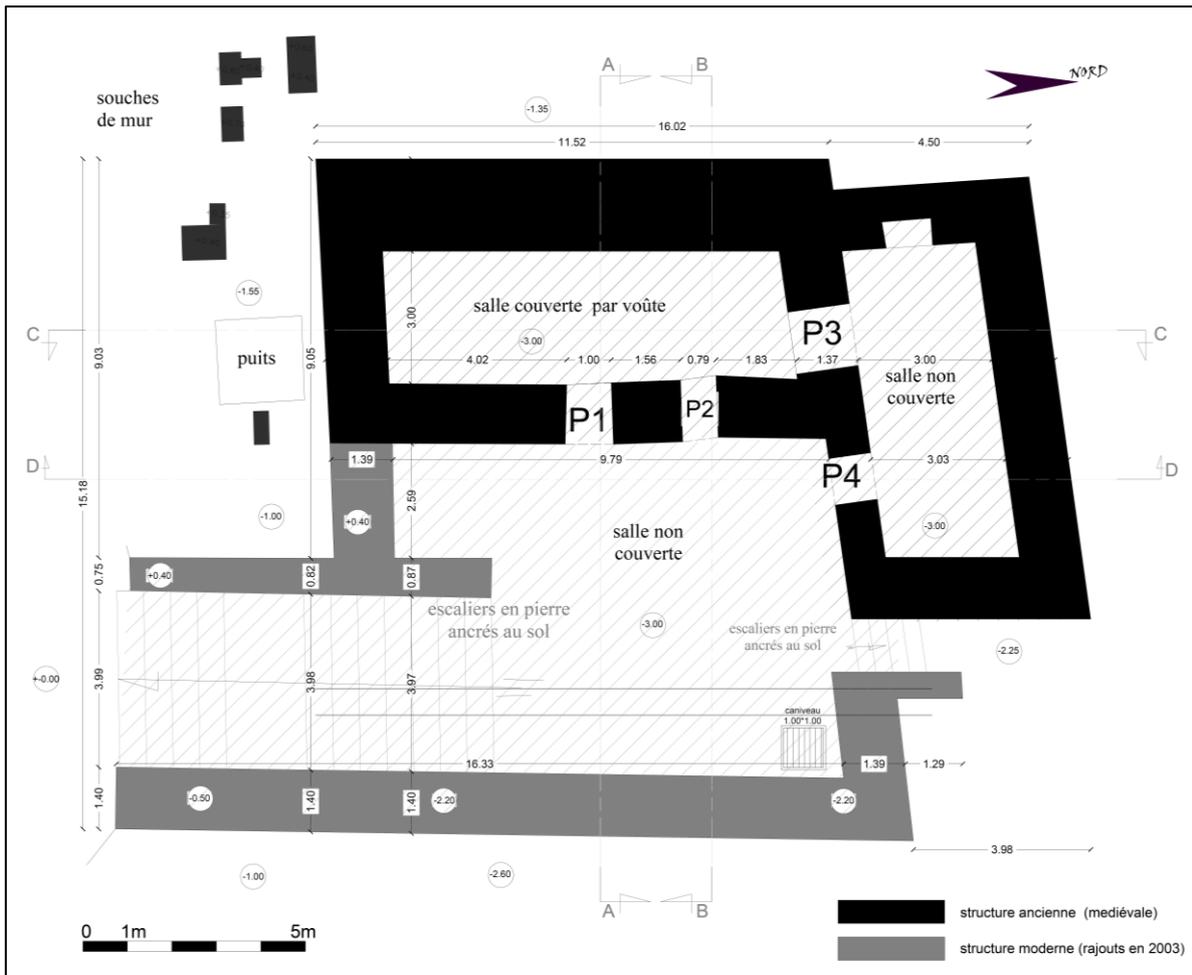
Plan rez de chaussée actuelle du bain d'Agadir sur format DWG. Source auteur
